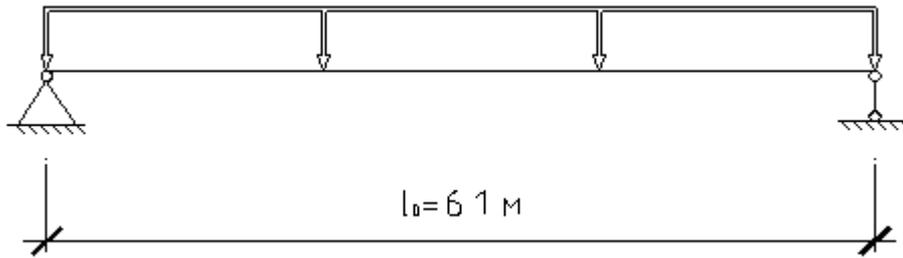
Схема завантаження багатопустотної панелі перекриття.
